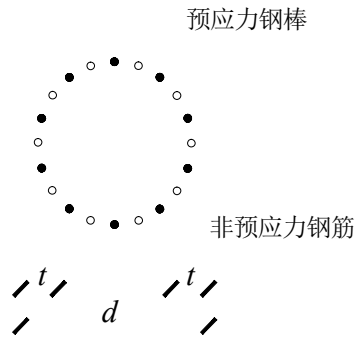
混合配筋混凝土管桩 (I 型)
